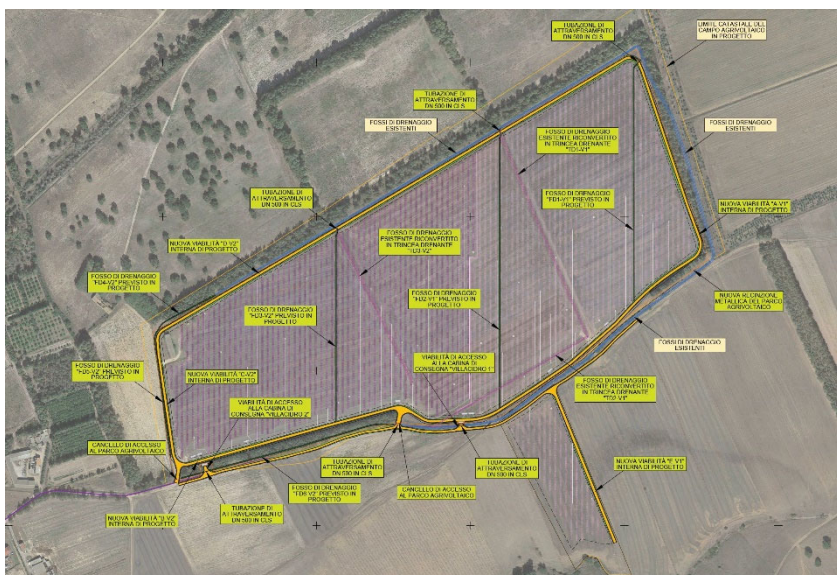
Schema planimetrico della viabilità perimetrale interna al campo agrivoltaico con fosso di drenaggio.
